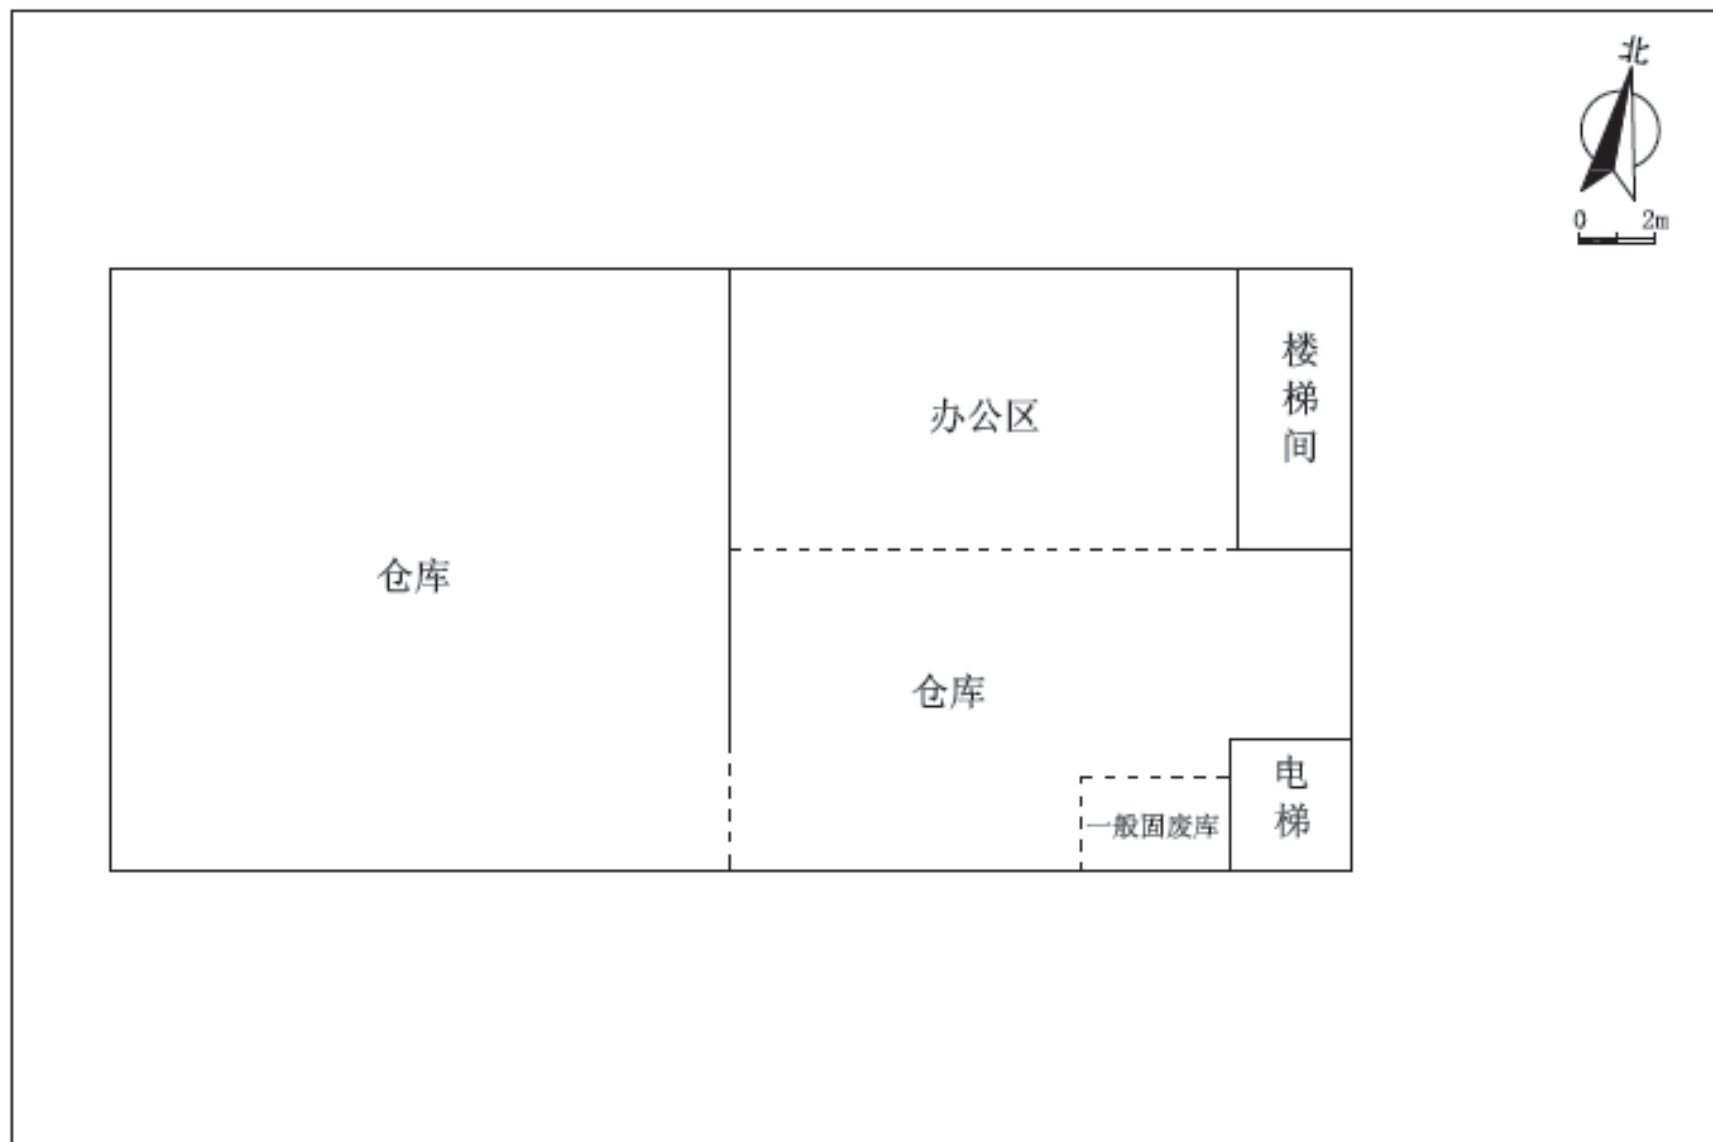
建设项目生产车间二层平面布置图（环评中图）
